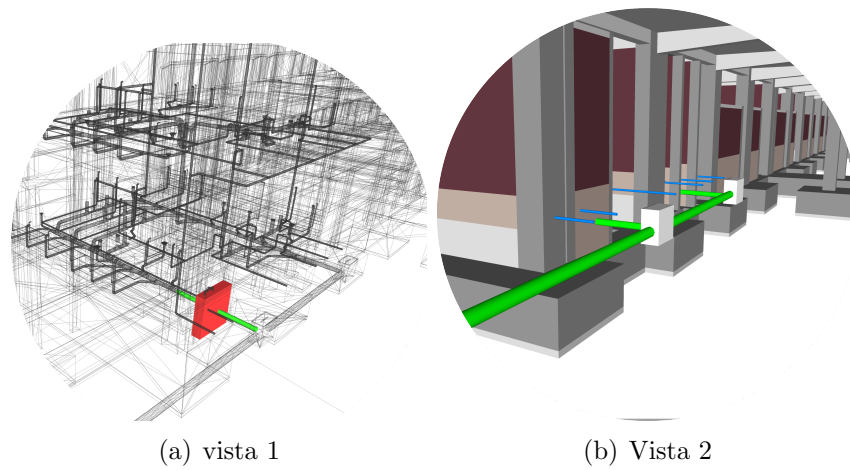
Conflicto entre tubería y sobrecimiento armado. *Fuente: Elaboración propia.
